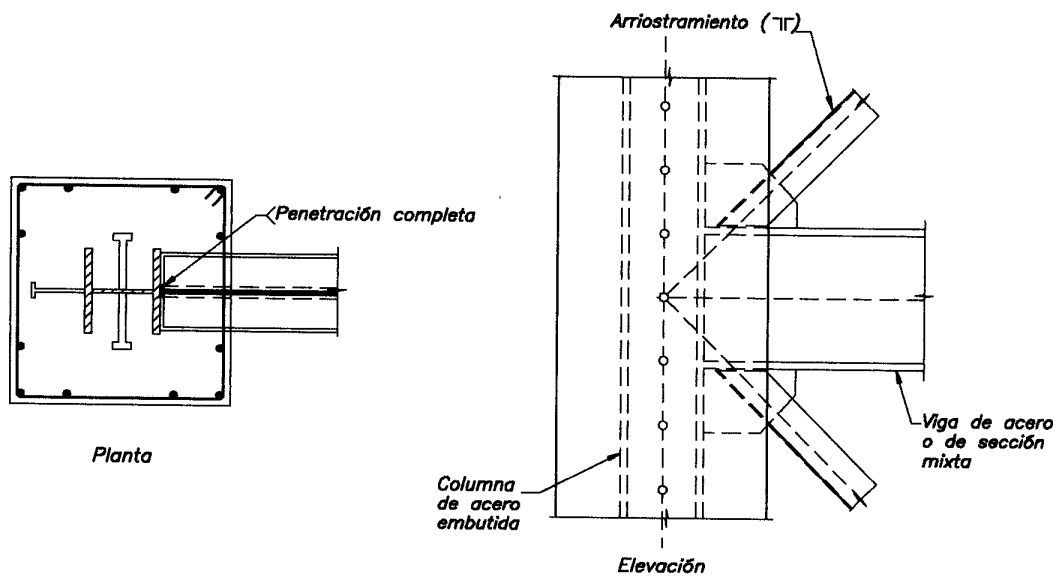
Construcción mixta acero-concreto con conexión sumergida.
